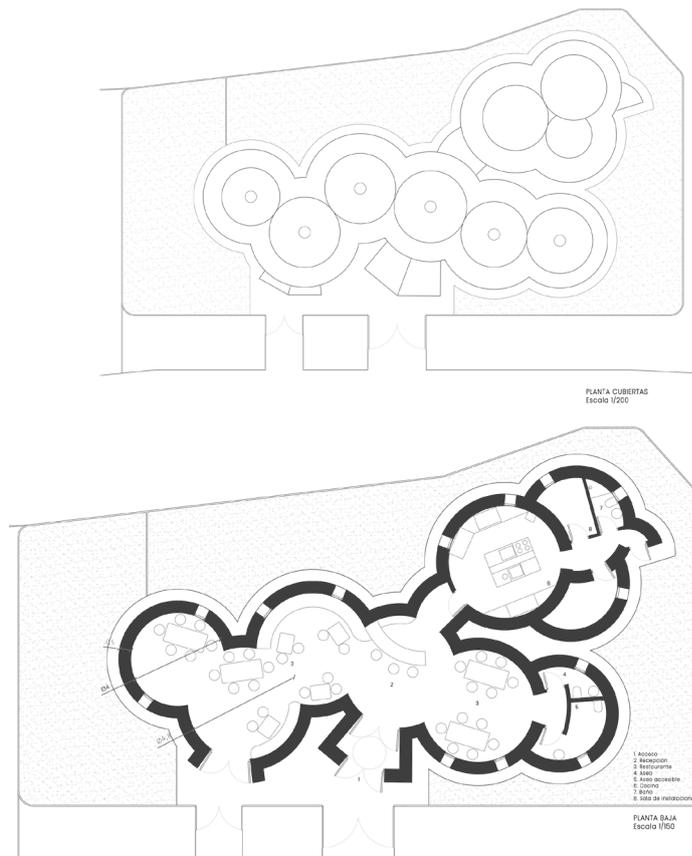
Plantas del restaurante. Ver anexo con documentación del proyecto.
